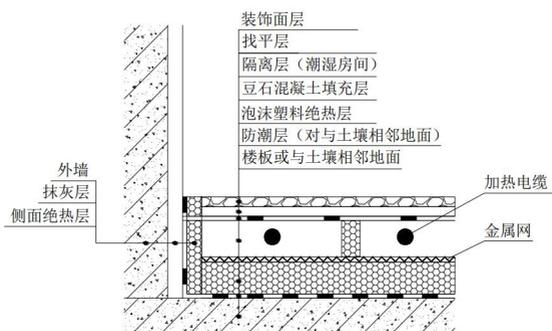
混凝土填充式加热电缆供暖地面构造
